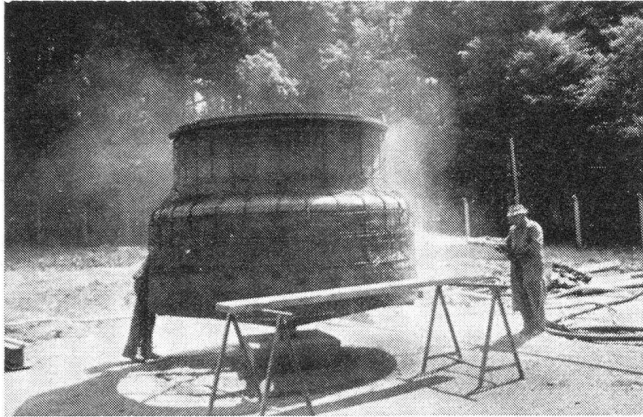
Ummantelung eines Elementes mit Spritzbeton auf dem Drehtisch
